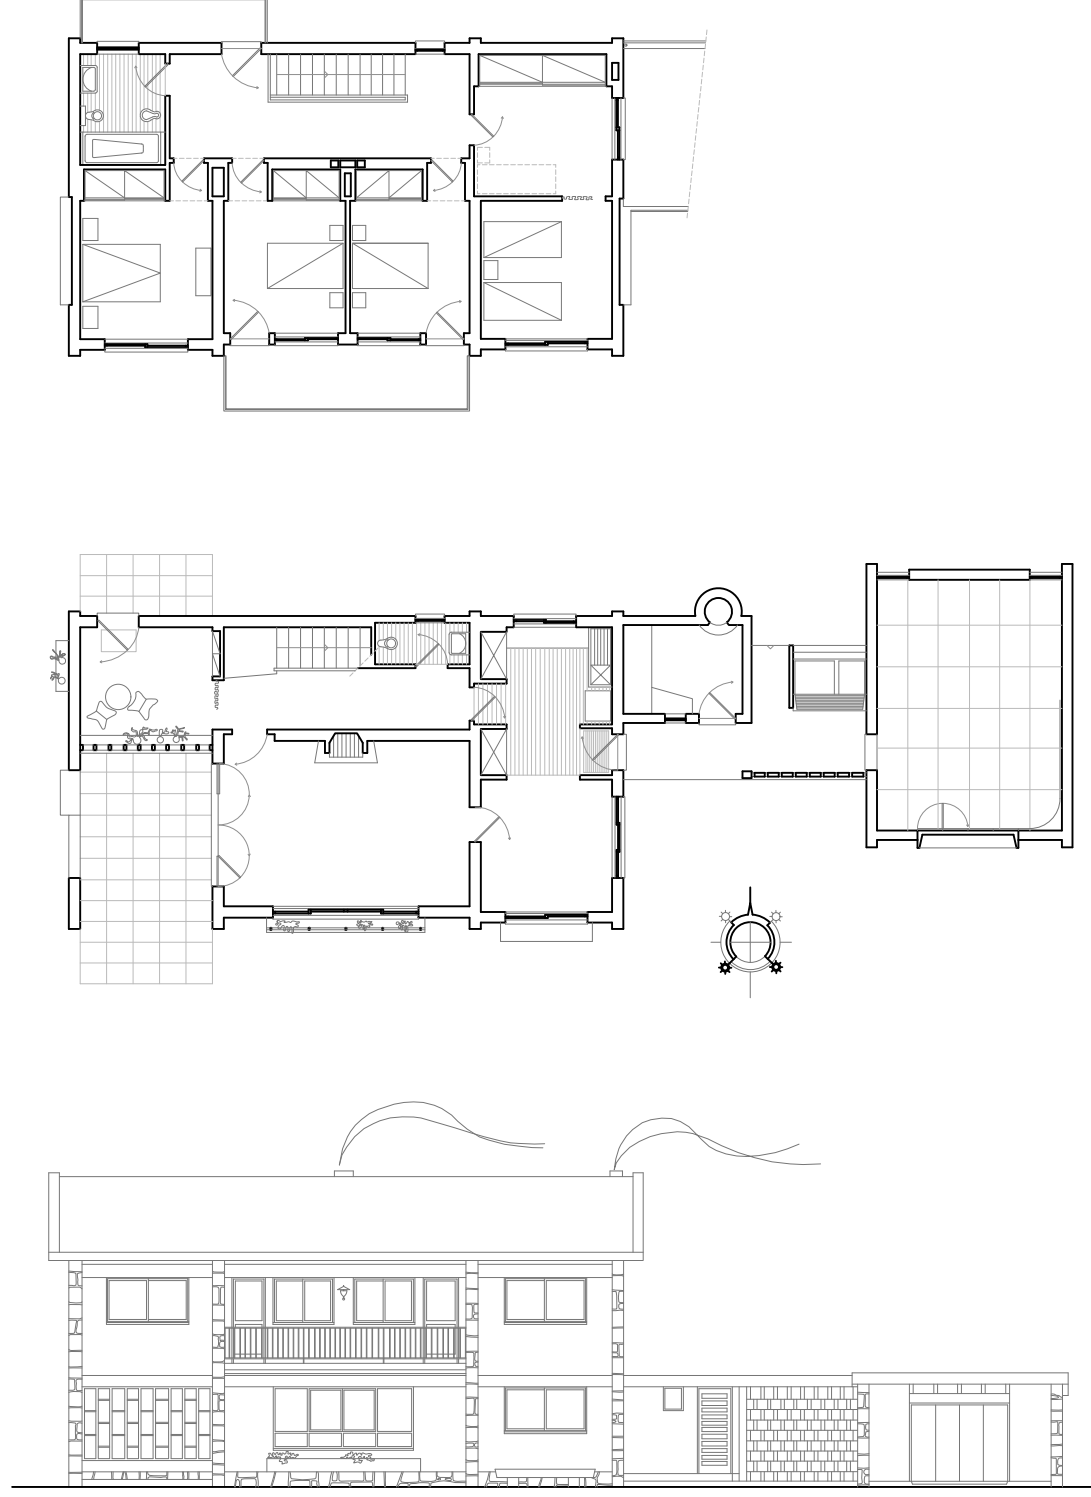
Planta de primeiro piso, planta de rés-do-chão e alçado sul da Casa Pereira de Vilar - escala 1:200.
